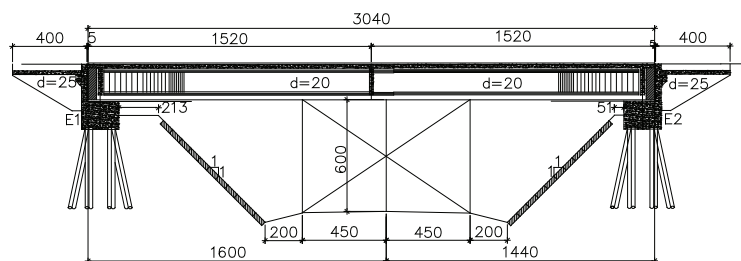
Corte longitudinal do viaduto - Modelo Estrutural I (unidades em cm)
